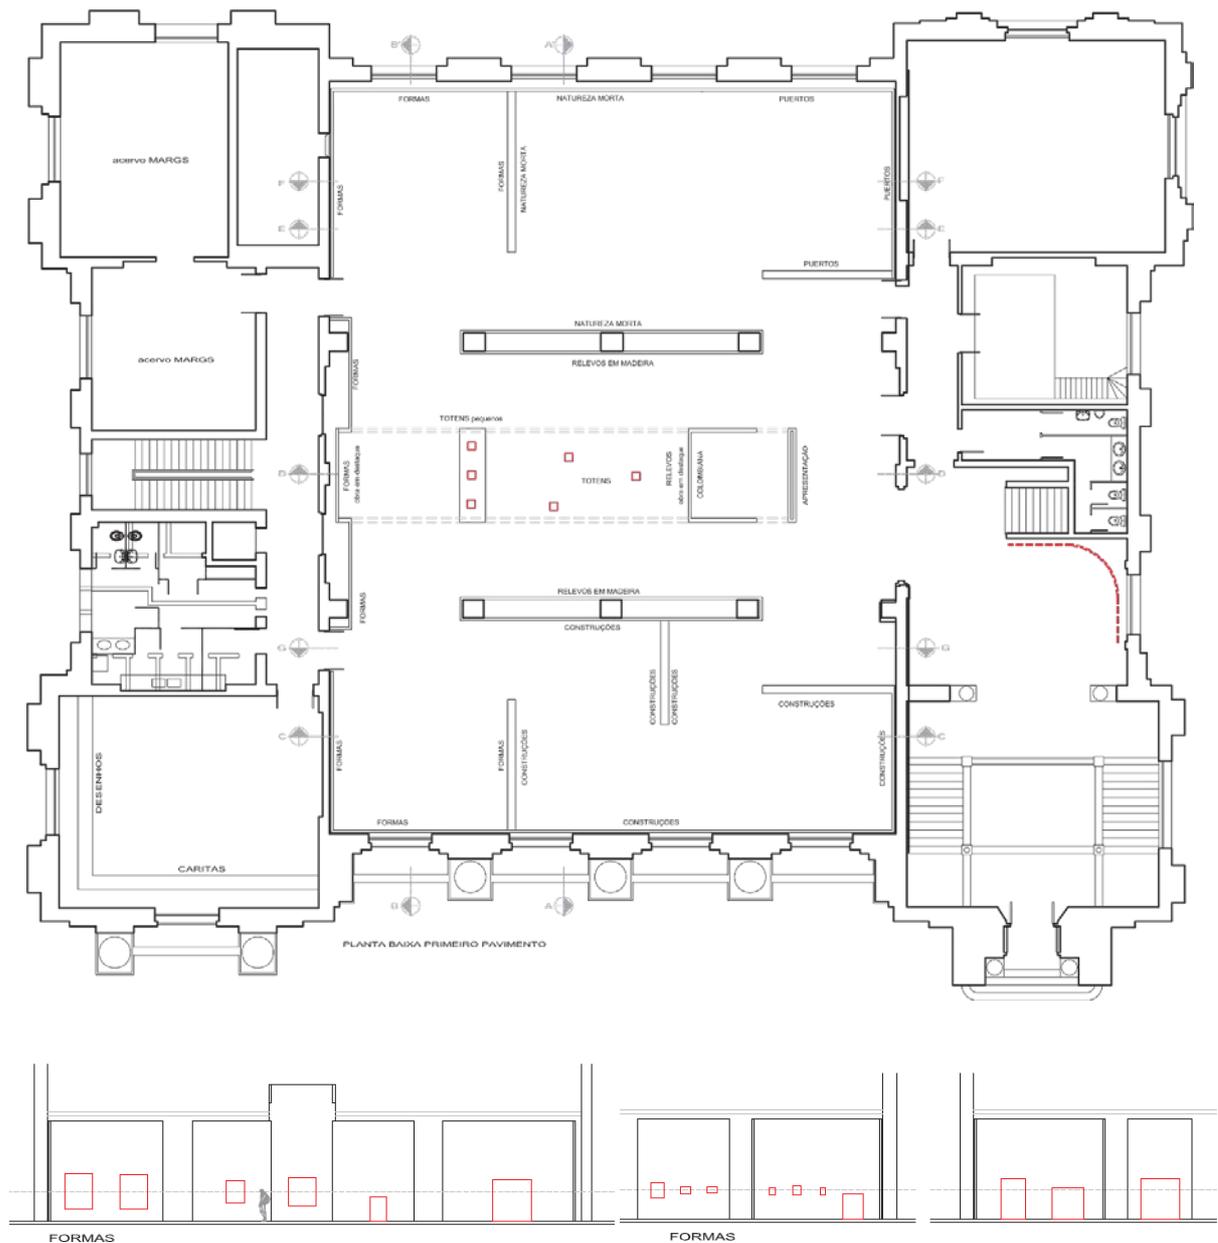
Planta baixa e corte indicando disposição das obras - primeiro pavimento MARGS – Mostra Francisco Matto
